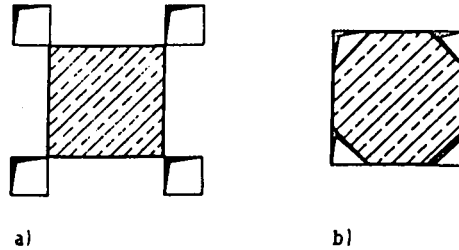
Aussparungen einer Flachdecke im Stützenbereich nach [P1],
